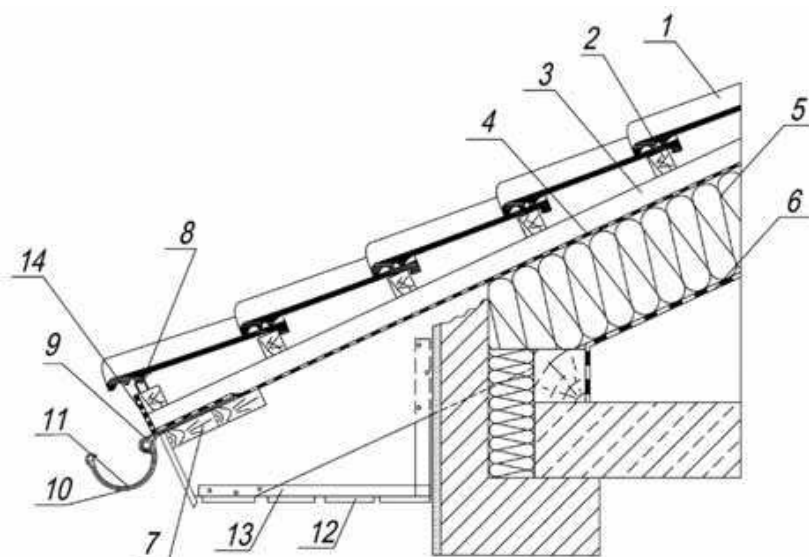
Карнизный свес с низкорасположенным жёлобом:
